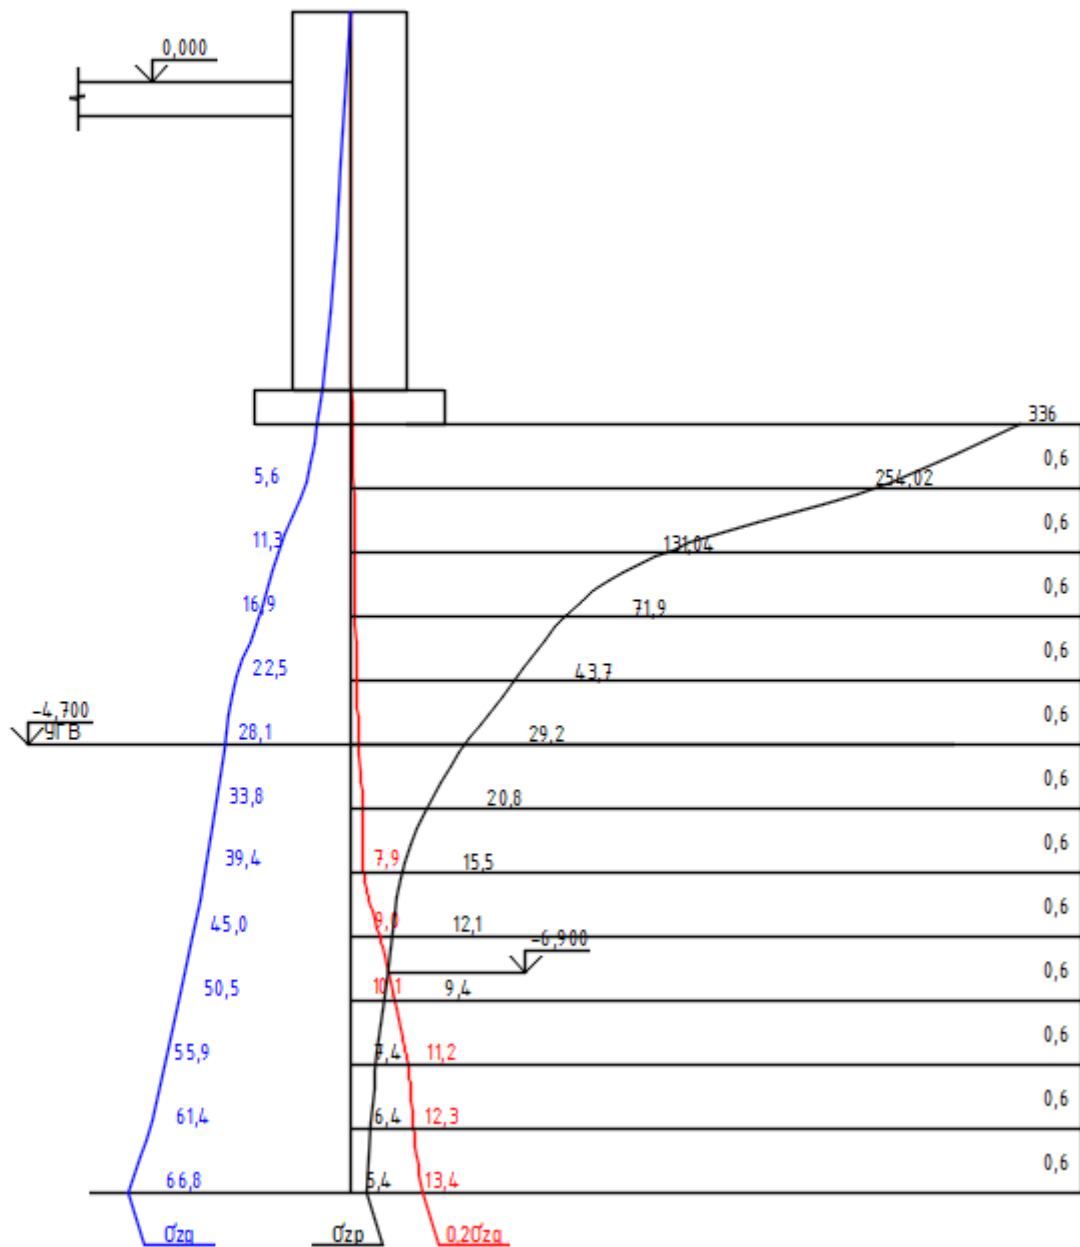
Эпюры напряжений под подошвой фундамента.
